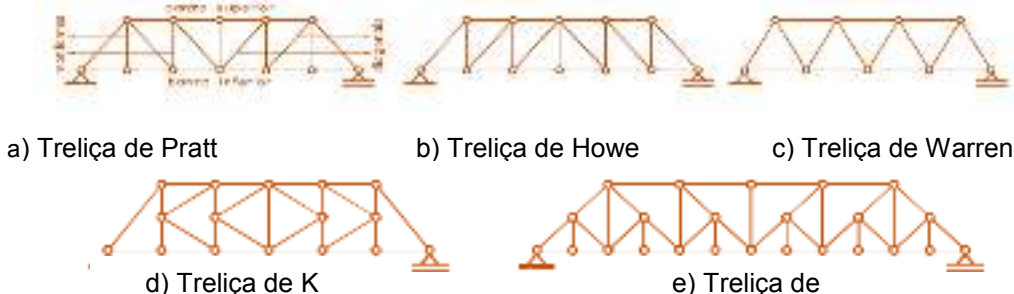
Tipos de treliças utilizadas em pontes ou passagens superiores. Fonte: J.L.Meriam, L.G.Kraige, Sexta Edição
